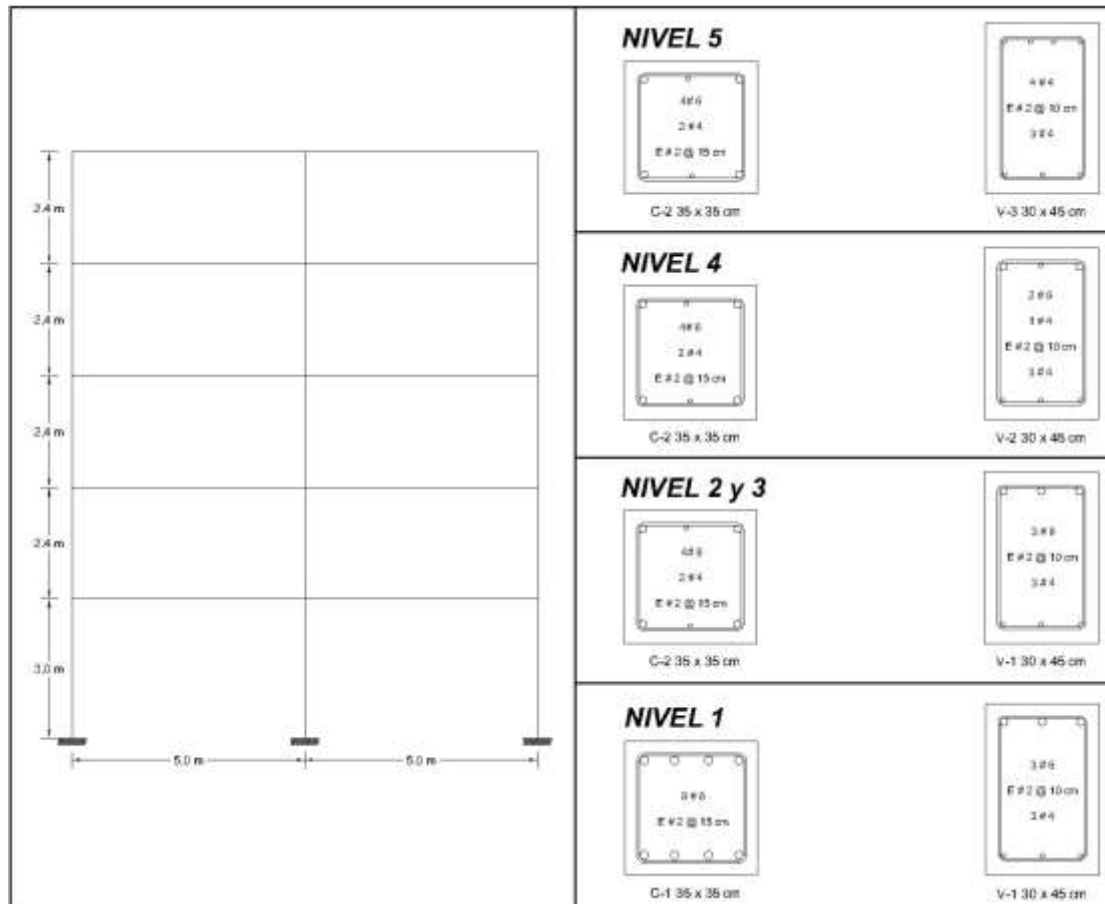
Armado de vigas y columnas para MCR de 5 con MDL diseñadas con el RCDF-1977 (DDF, 1977a)
